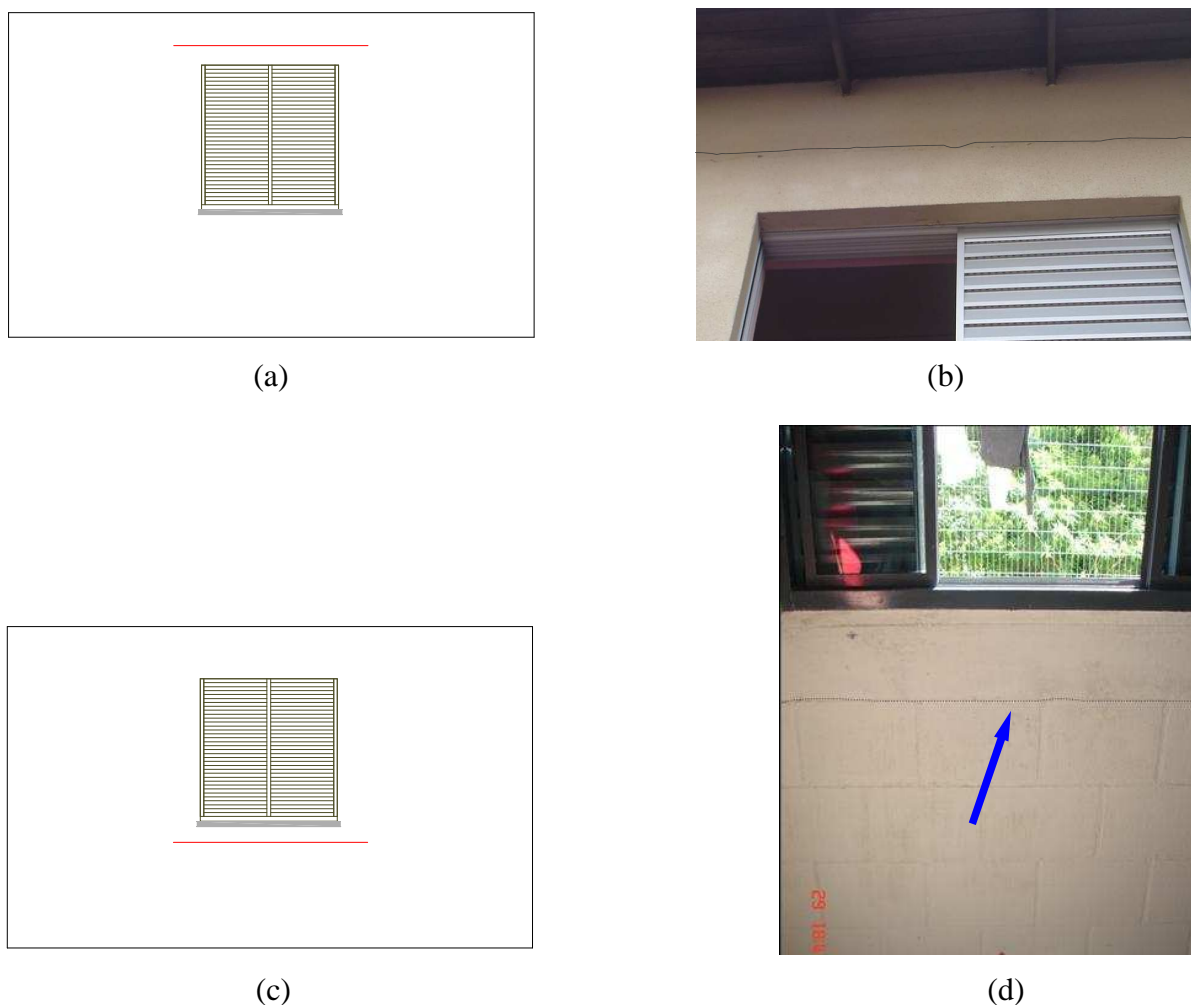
(a) Configuração típica de fissura horizontal uma fiada acima da janela; (b) caso de fissura horizontal uma fiada acima da janela; (c) Configuração típica de fissura horizontal uma fiada abaixo da janela. (d) caso de fissura horizontal uma fiada abaixo da janela.
